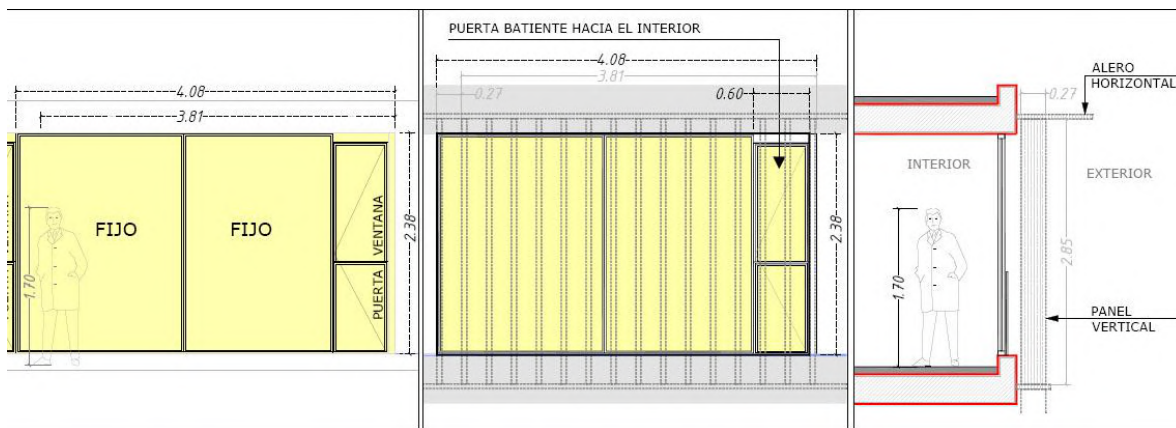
Ventanal a borde de losa de la fachada noroeste y propuesta de parasol de celosías verticales rotatorias y plegables
